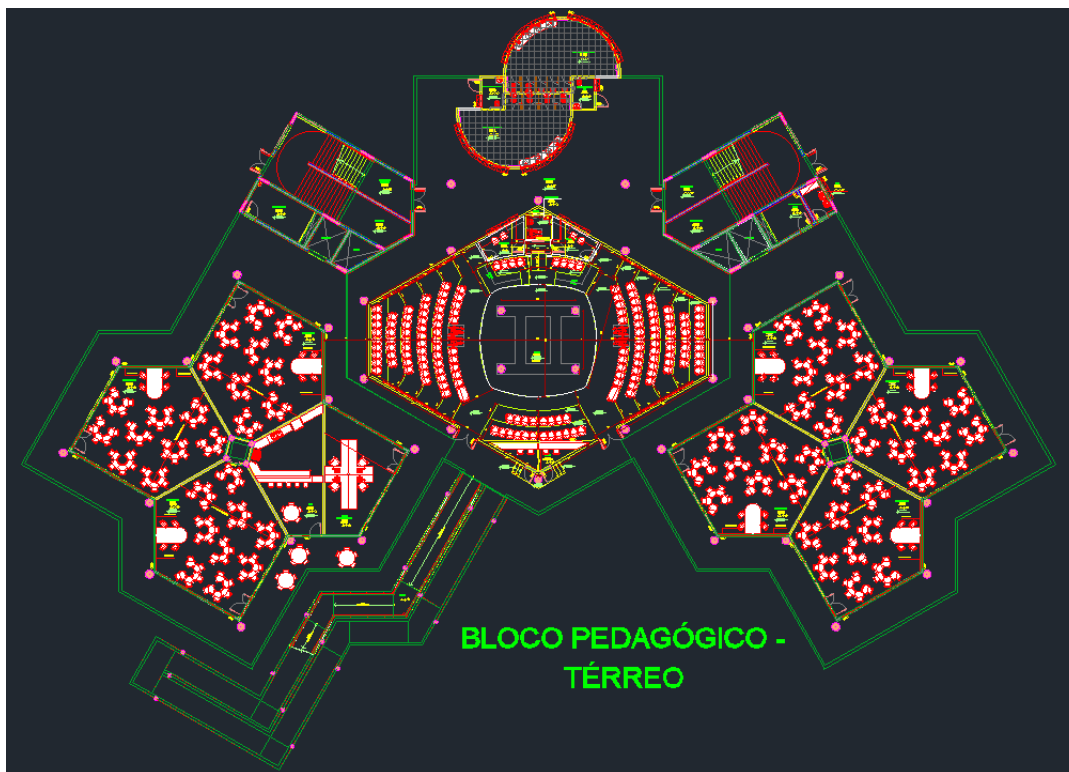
Planta Baixa do pavimento térreo do Núcleo Pedagógico CJA UFSB
